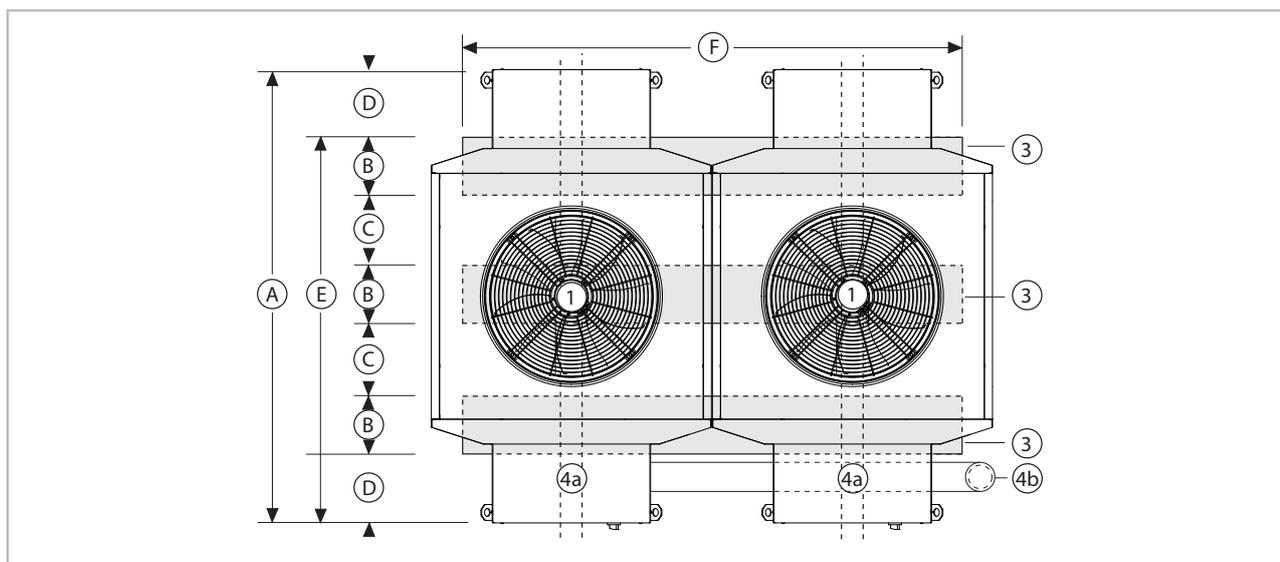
Dimensions des semelles filantes (vue de dessus)
